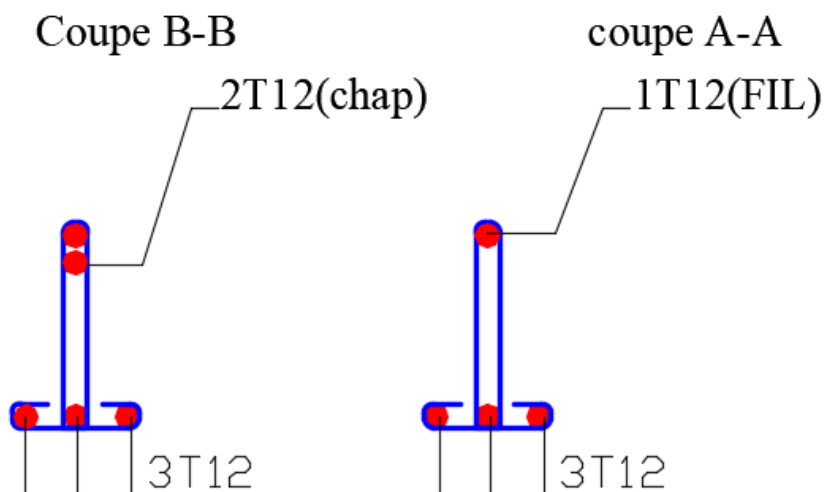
Schéma de ferrailage de la poutrelle
